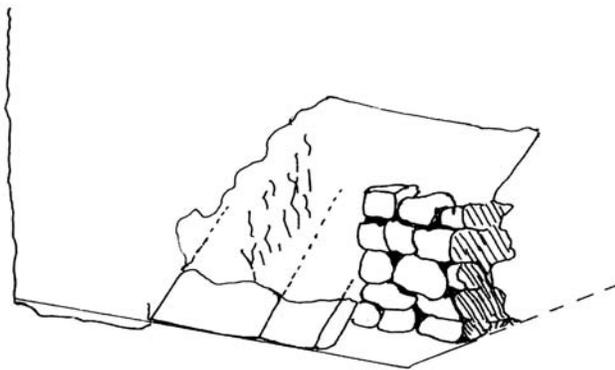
Núcleo urbano de Tula Grande, juego de pelota 2. Detalle del sistema constructivo del recubrimiento que forma la banqueta de losas y el muro de contención señalado en la figura anterior (redibujado después de H. Moedano).
